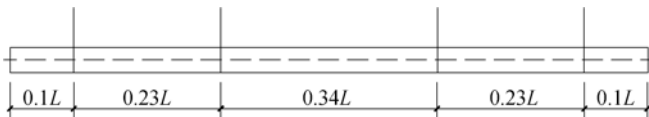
长度大于 15m 且不大于 30m 的预应力混凝土桩吊点位置
